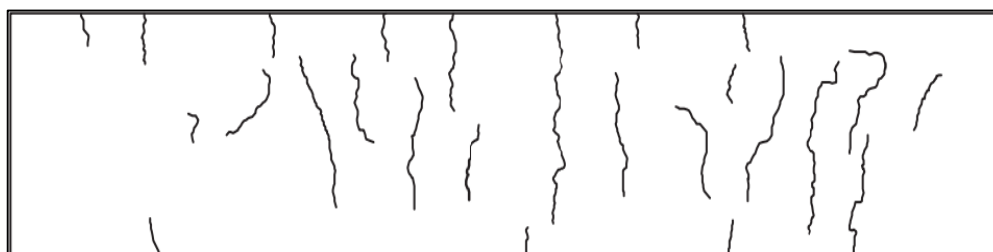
Exemple de maillage de fissuration sur support adhérent (Juarez et al., 2015)
